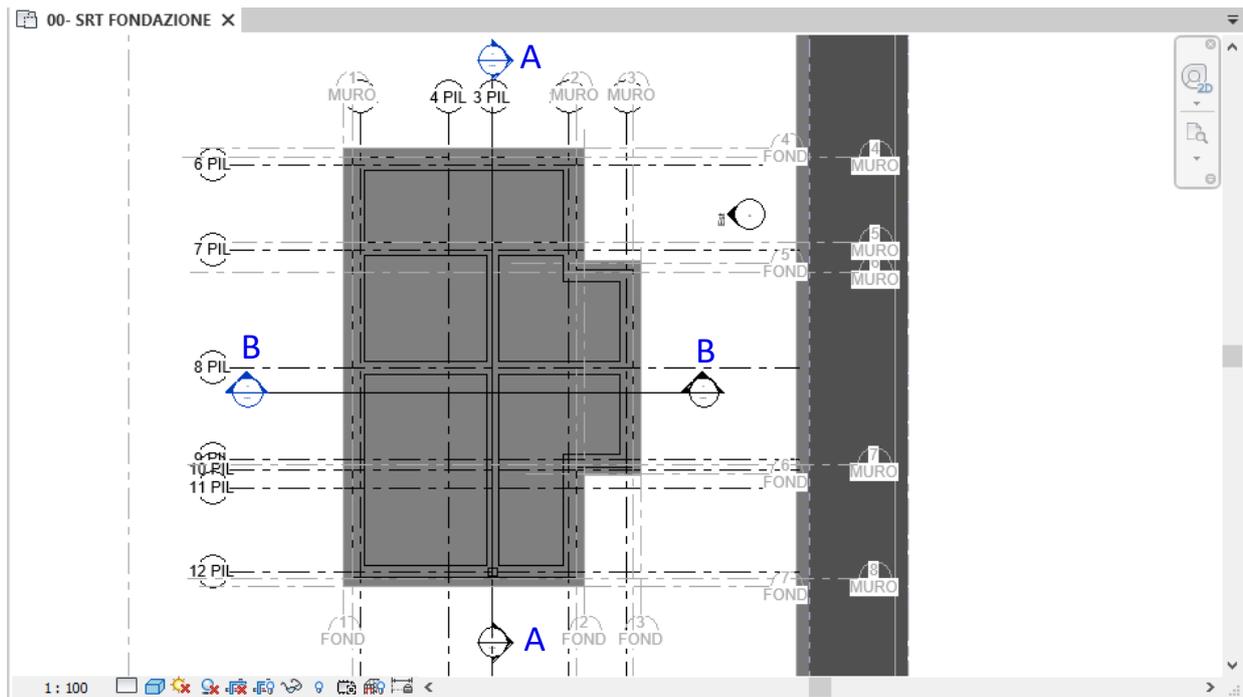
Vista 00-STR FONDAZIONE: Pianta delle fondazioni modello strutturale
